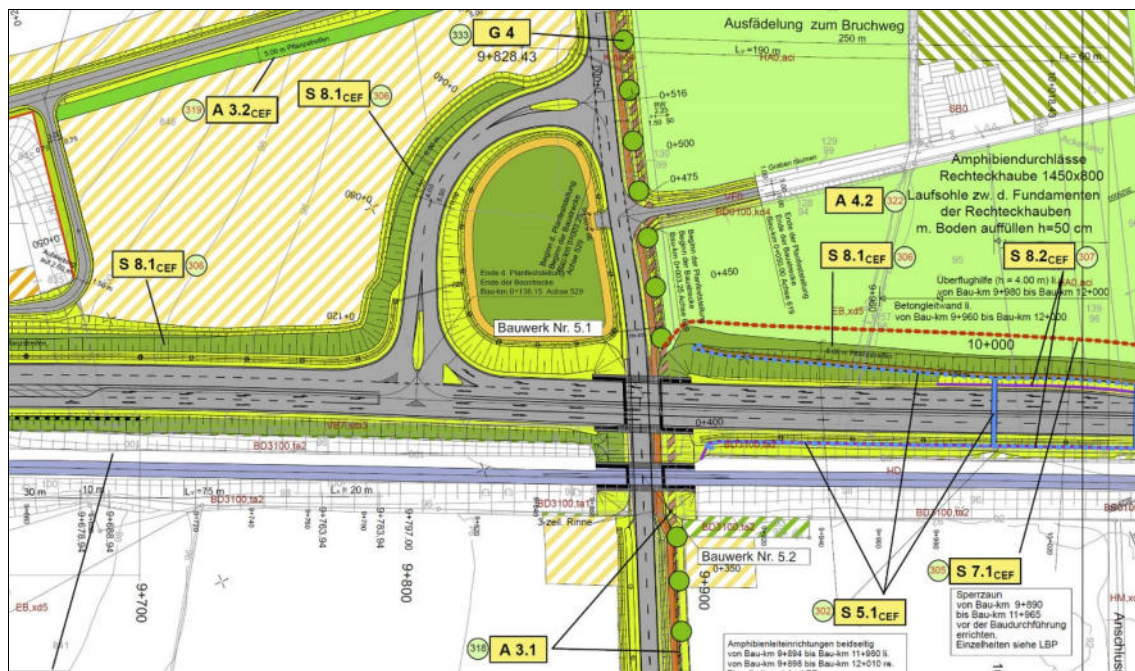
Ausschnitt aus dem Maßnahmenlageplan des LBP zu FR 7.
